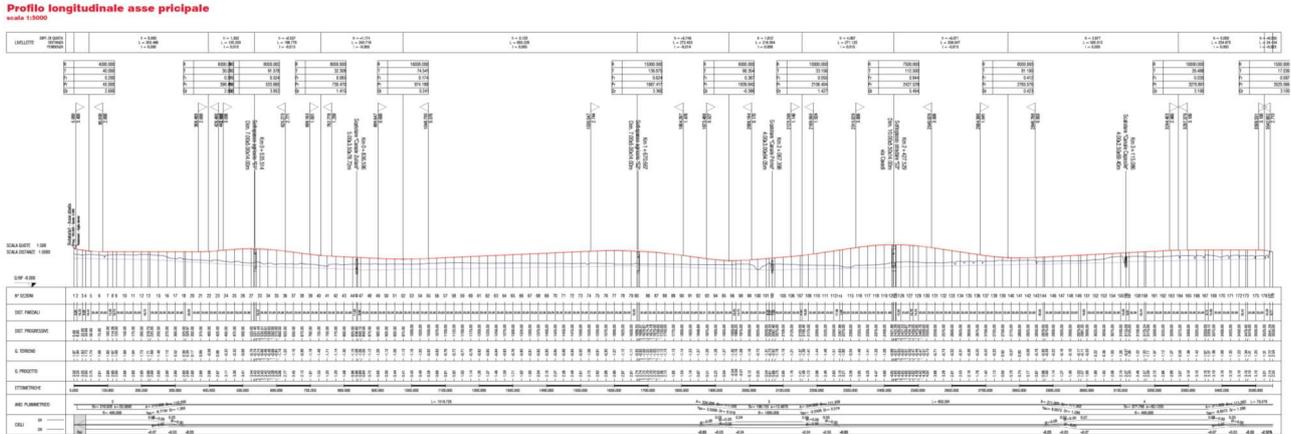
PROFILO DELL'INFRASTRUTTURA DI PROGETTO
